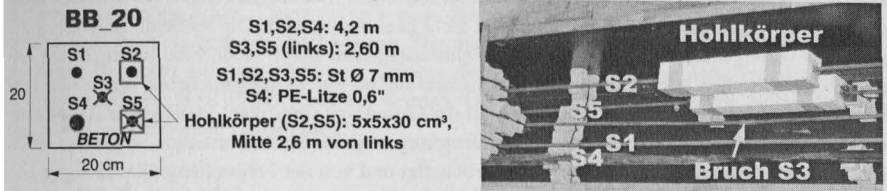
Versuch *BB_20*: Bauteilquerschnitt mit Details zur Art, Länge und Lage der Stäbe und der beiden quaderförmigen, 30 cm langen Aussparungskörper sowie Photo der präparierten Stäbe vor der Betonage; die Stabüberstände an den Betonstirnseiten betragen beiderseits 10 cm
